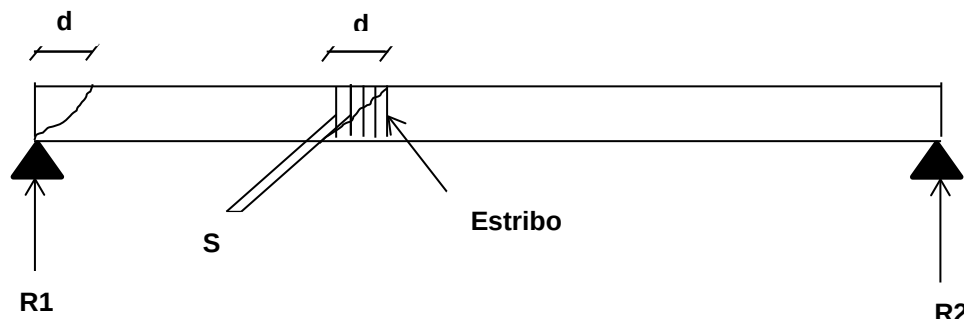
Espaciamiento de estribos y tipo de agrietamiento por cortante.
